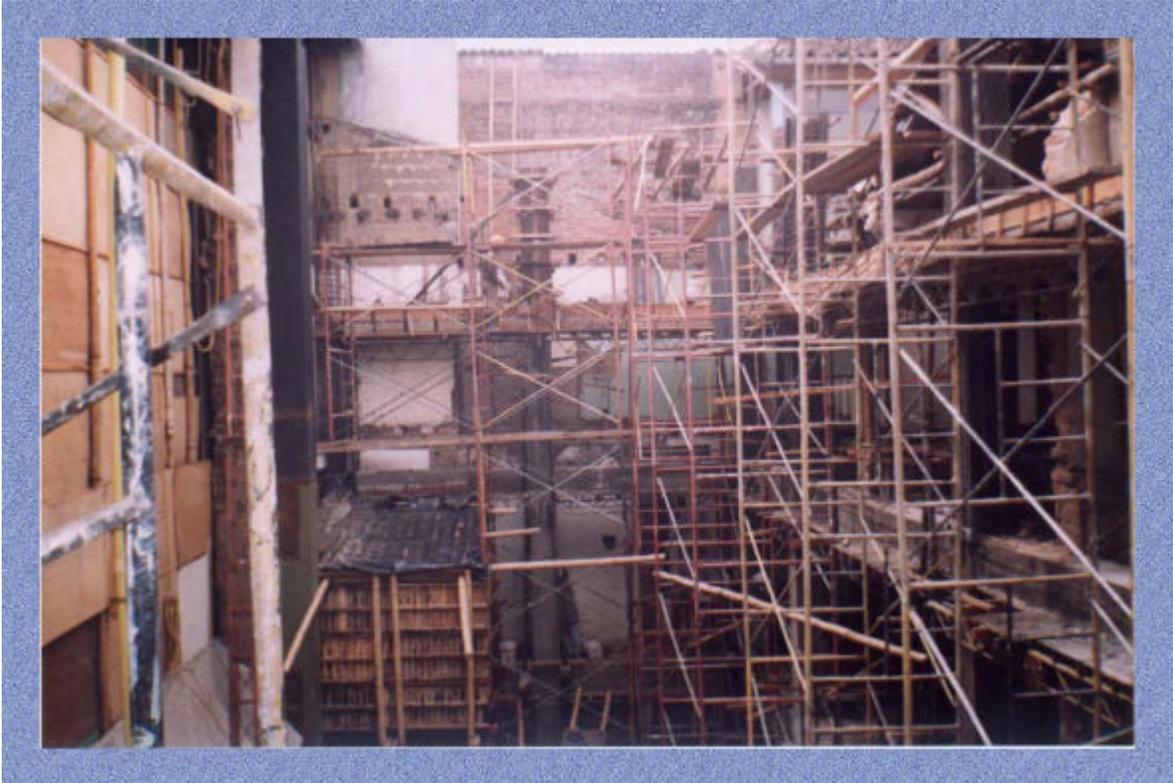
Realizaron últimos detalles para poder fundir las ménsulas
